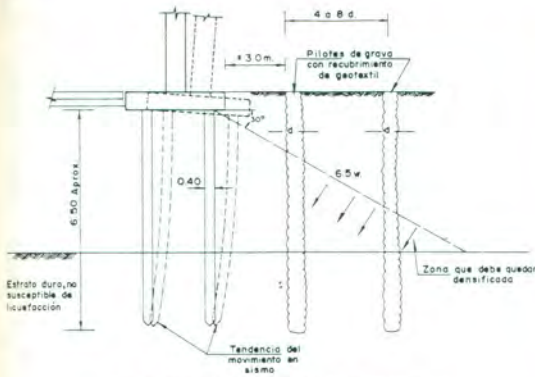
ESQUEMA DE COLUMNAS DE PIEDRA
